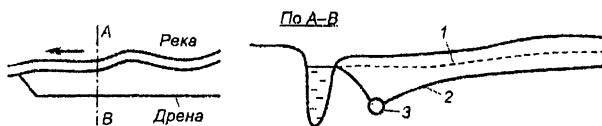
Береговой дренаж: 1 — уровень грунтовых вод (УГВ) до осушения; 2 — УГВ после осушения; 3 — дрена
